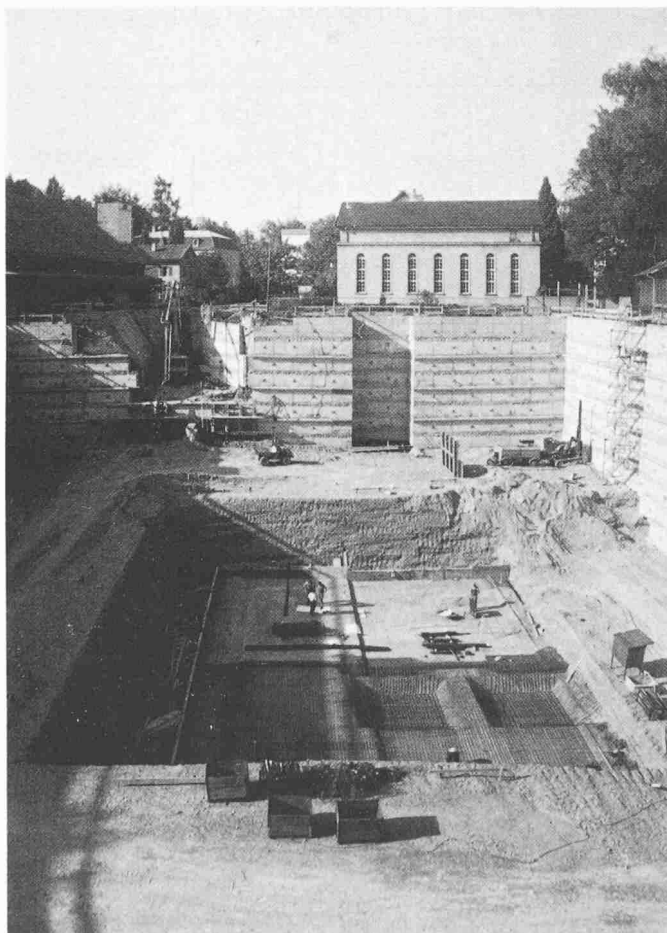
Übersicht über die fertig ausgehobene Baugrube. Im Hintergrund werden die letzten Elemente im Zusammenhang mit der Ausfahrtsrampe betoniert. Daneben erkennt man den Schacht für die Nottreppenhäuser
